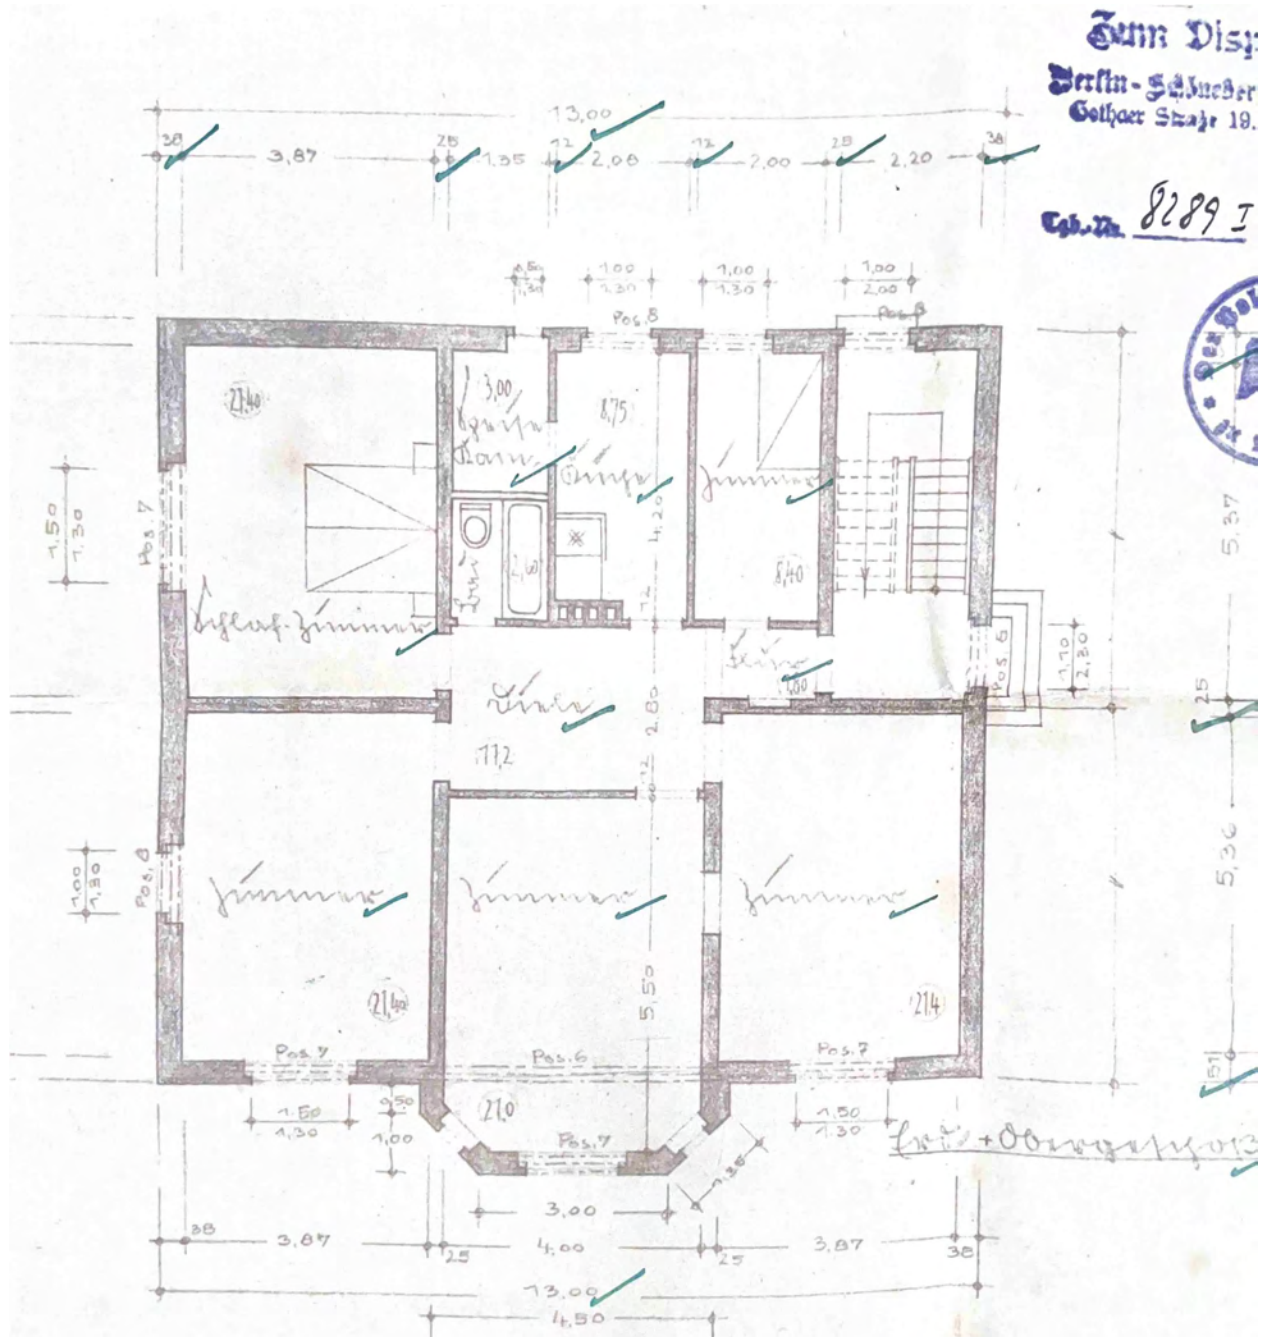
bauzeitlicher Grundriss Erd- und Obergeschoss
